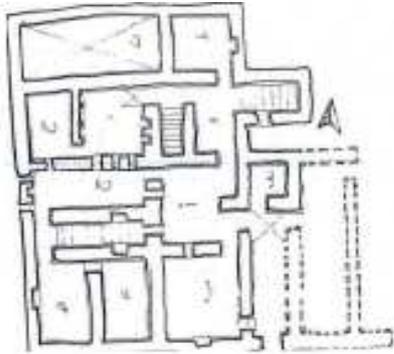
مسقط أفقي للمرحاض بدور درب السندادية
